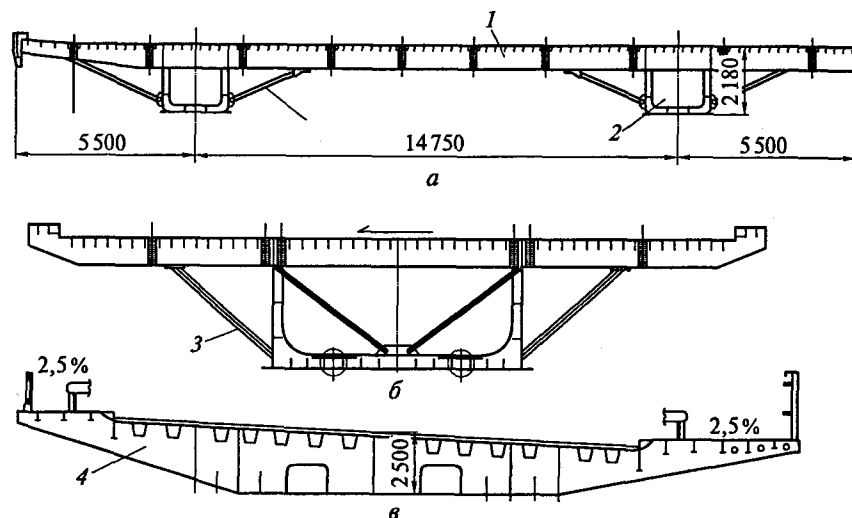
Конструкция цельнометаллических пролетных строений эстакад: а — полуоткрытого сечения; б — одноконтурного сечения; в — с наклонным верхним поясом; 1 — ортотропная плита проезжей части; 2 — коробчатая балка; 3 — подкос; 4 — поперечная балка
